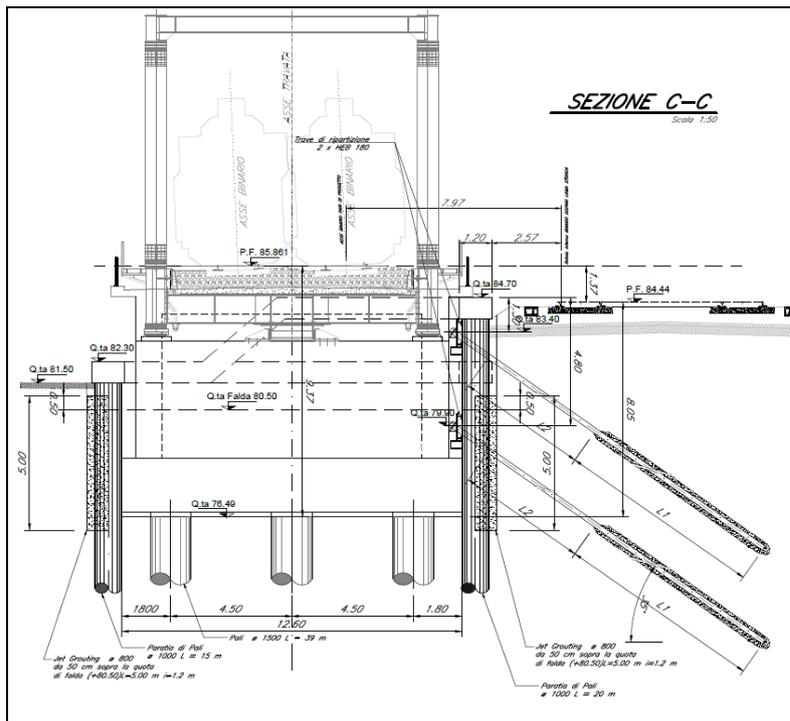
Sezione trasversale spalla lato Pavia. Particolare delle opere di sostegno propedeutiche alla realizzazione della spalla.
